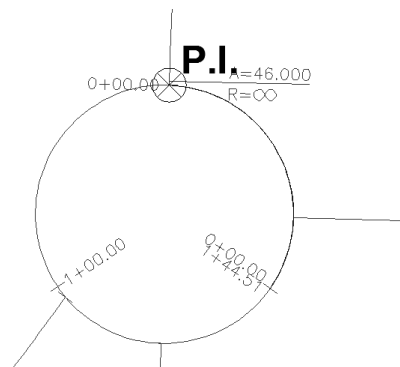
Intersecção em Planta entre o eixo do Restabelecimento 3 e a Rotunda B
